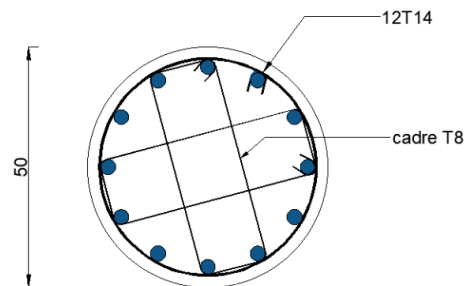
schéma de ferrailage des poteaux circulaires de 4^{me} et 5^{ème}
